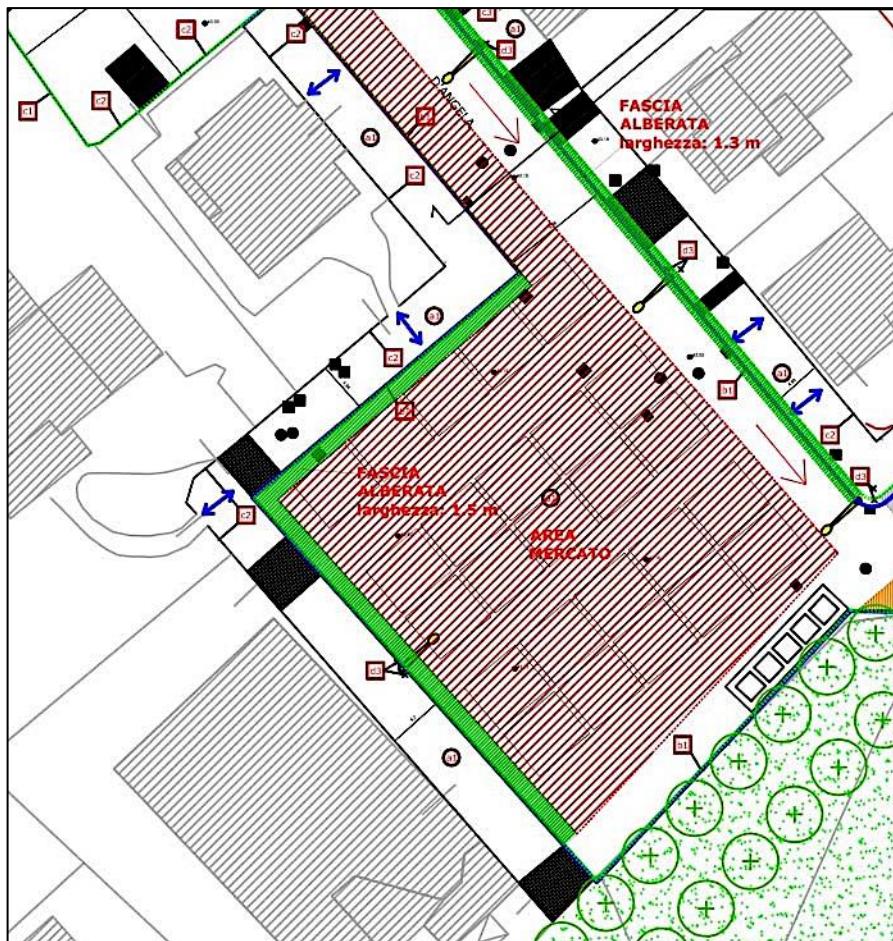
Estratto planimetria di progetto Piazza su via Attilio D'Angela
